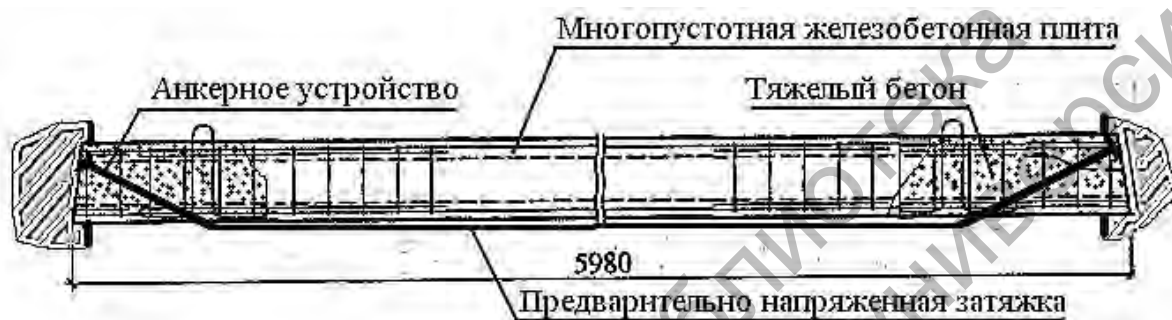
Предлагаемая схема усиления многопустотной железобетонной плиты
